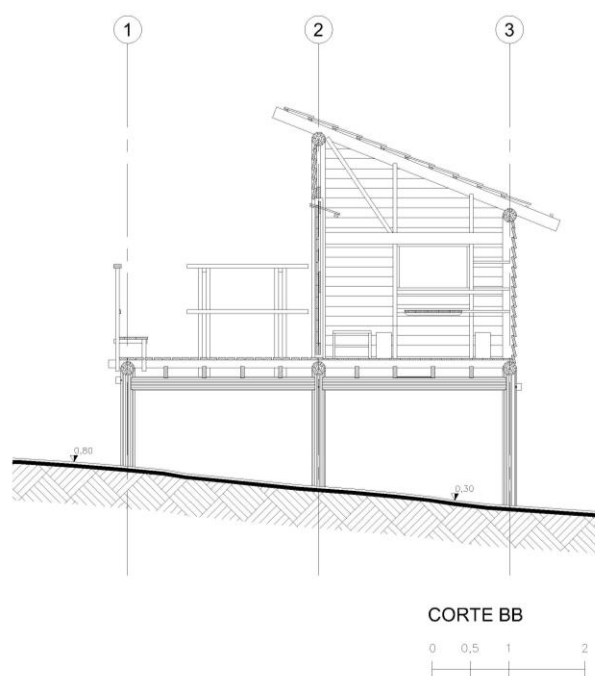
Desenho técnico do Corte BB. Desenho: Alexander Chang.
